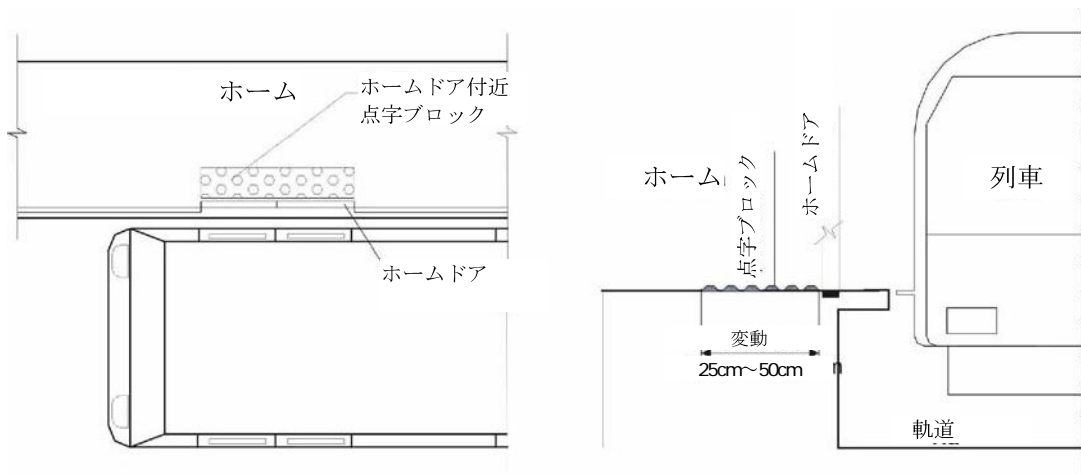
ホームドアが設置されているホームの点字ブロック（平面図、断面図）
